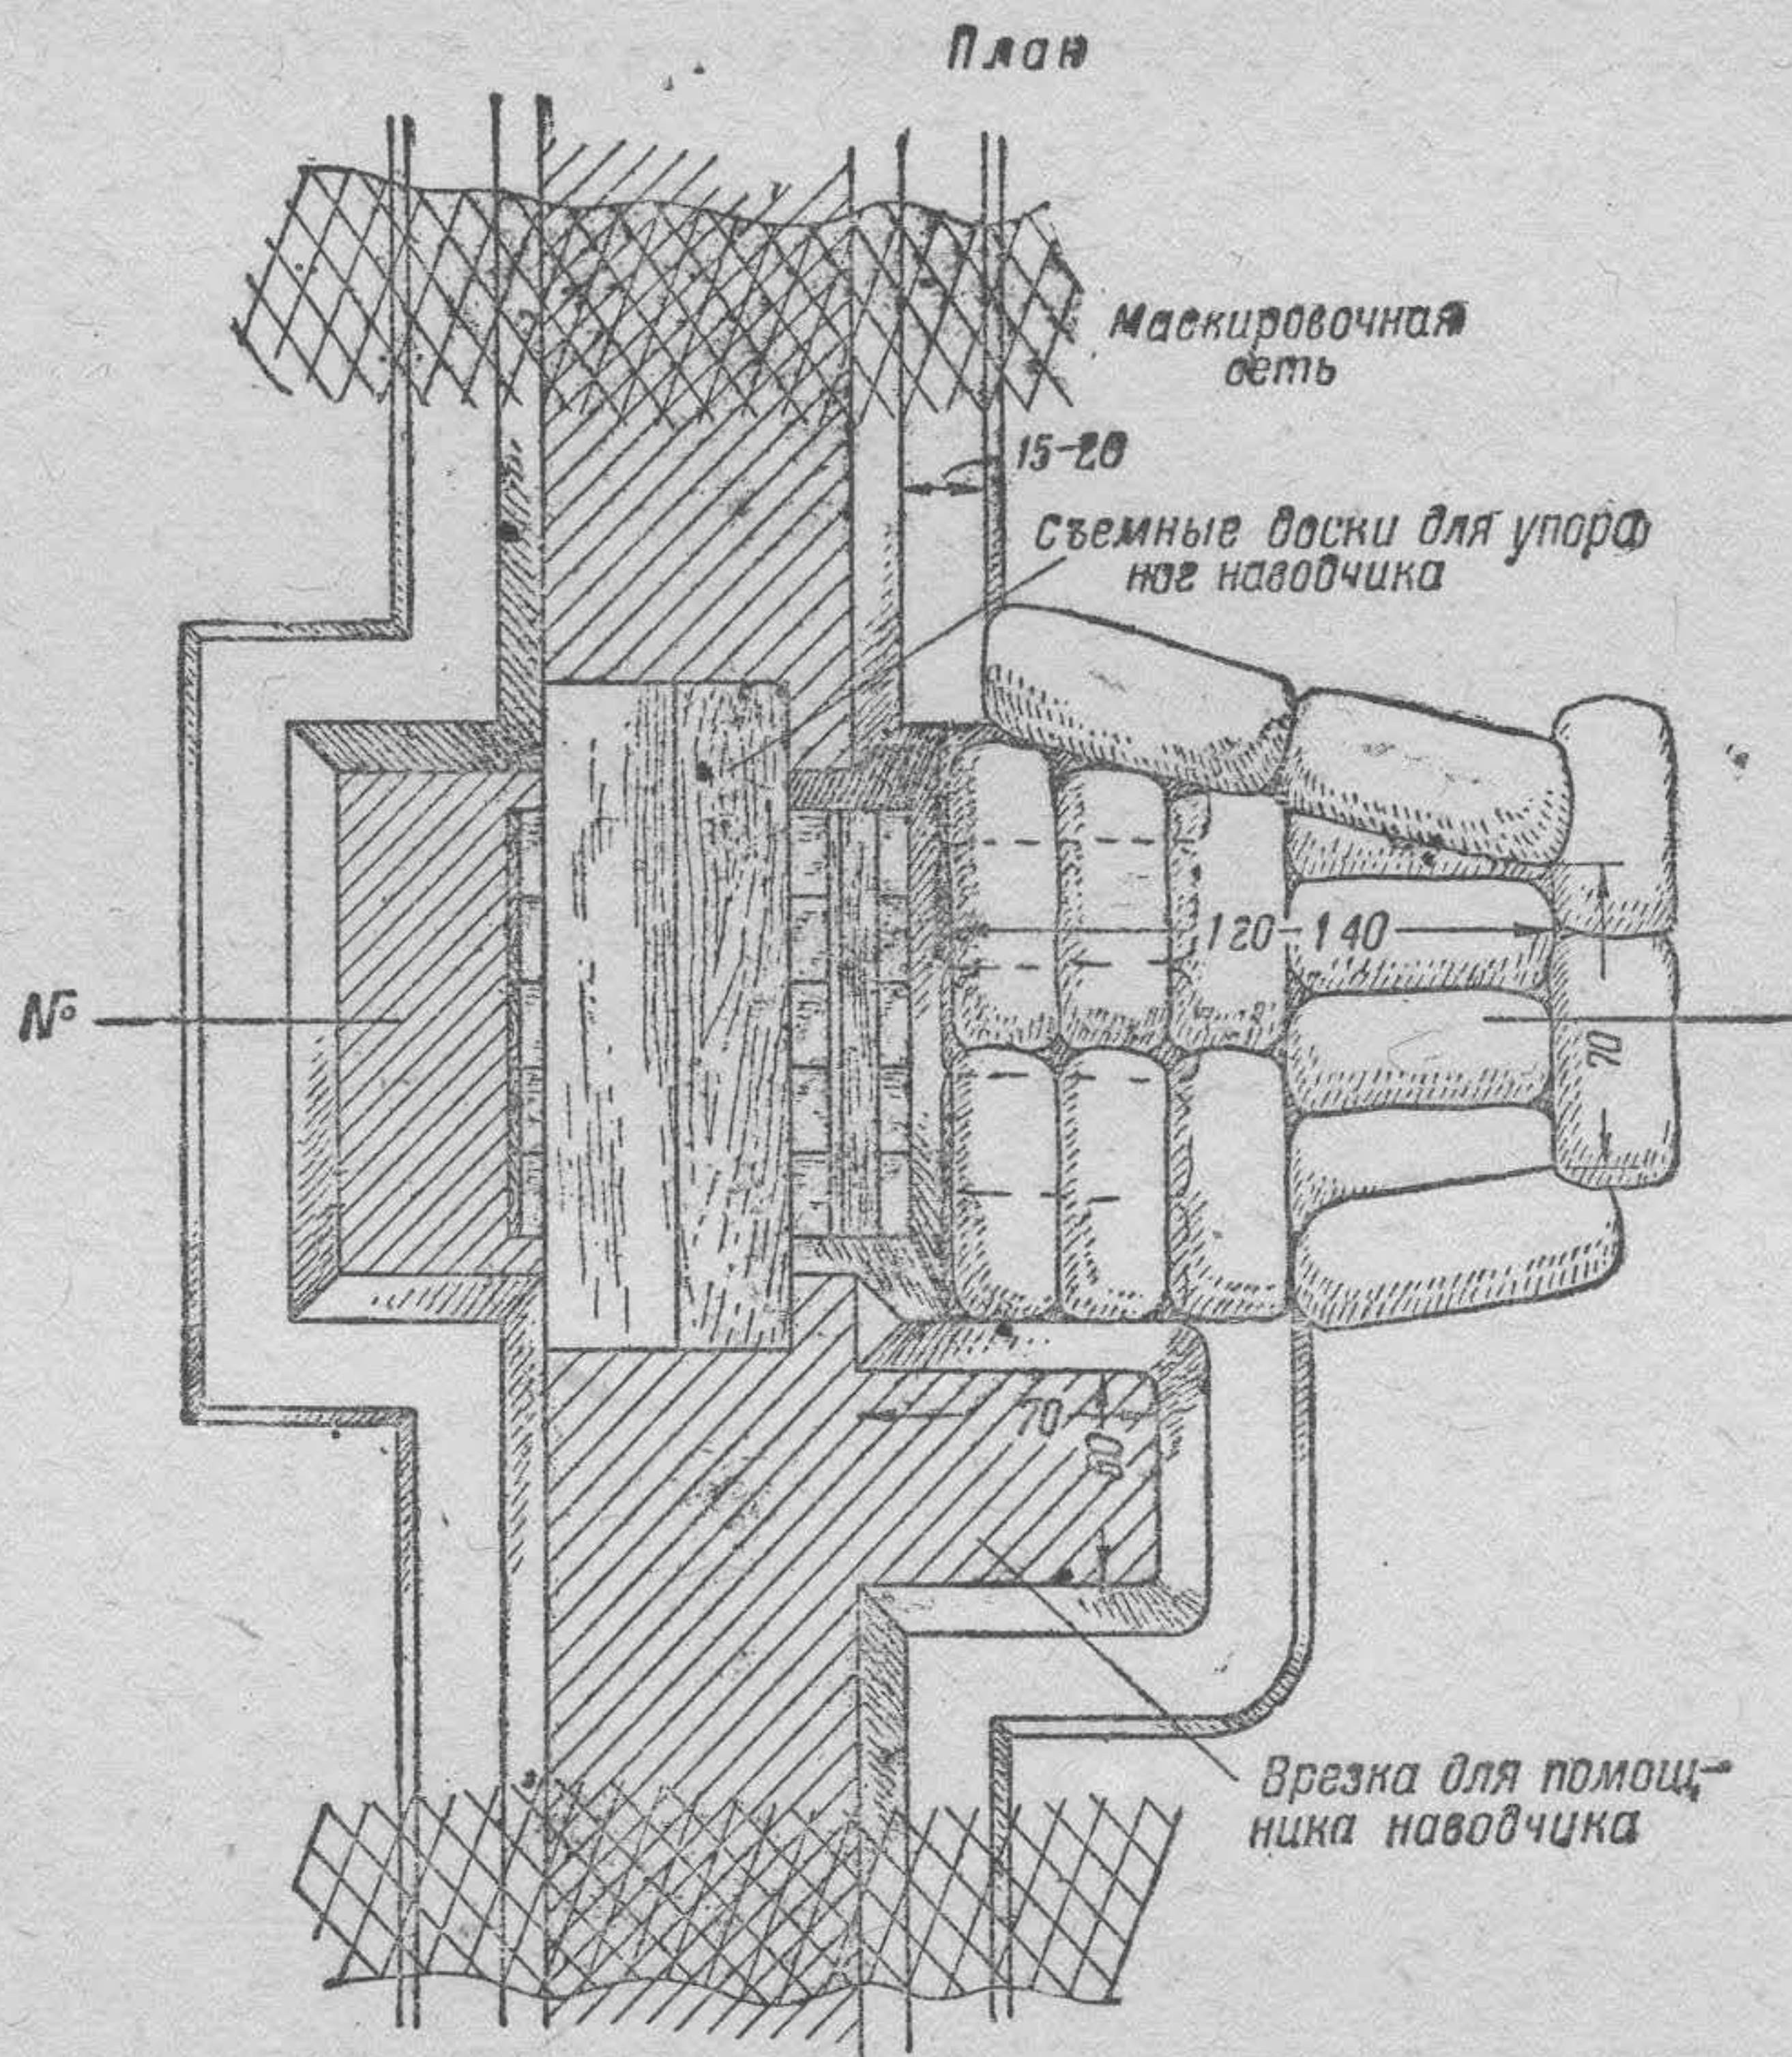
, А. Открытое пулеметное гнездо с укрытием-нишей (план)
